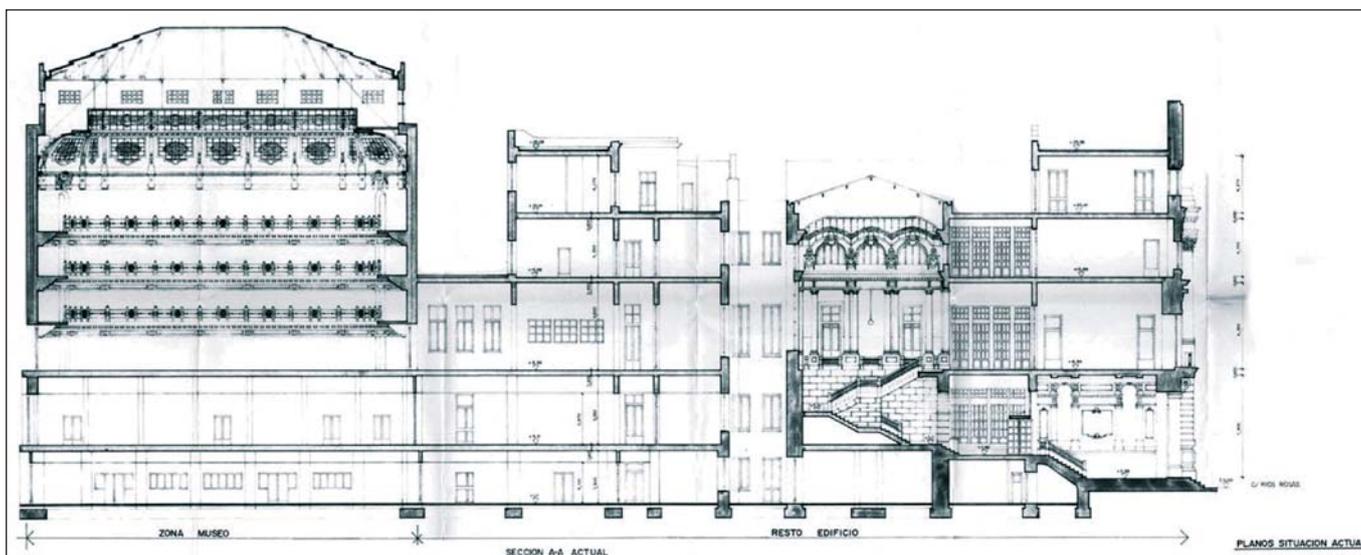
Sección actual de edificio en el proyecto de restauración, 1986 (AH.IGME).
